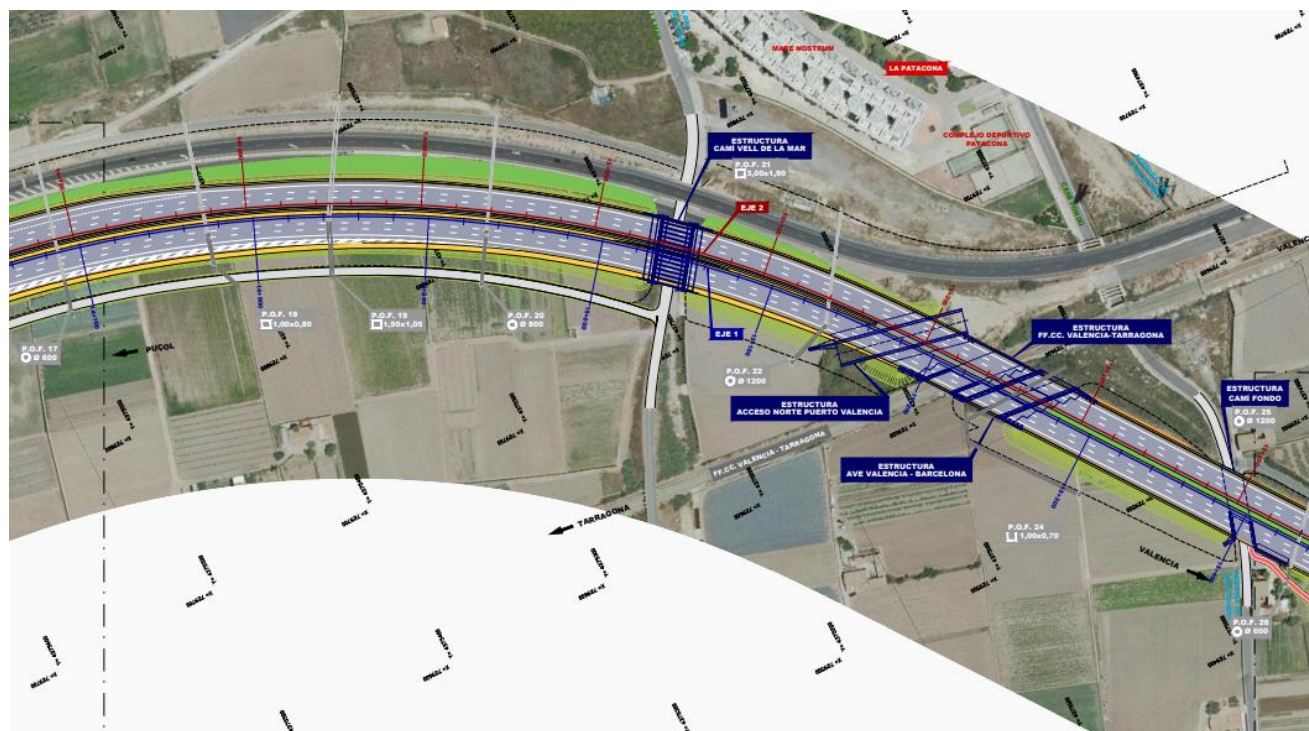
Planta del trazado. PK 15+000 - 15+500. Fuente: Proyecto de construcción
